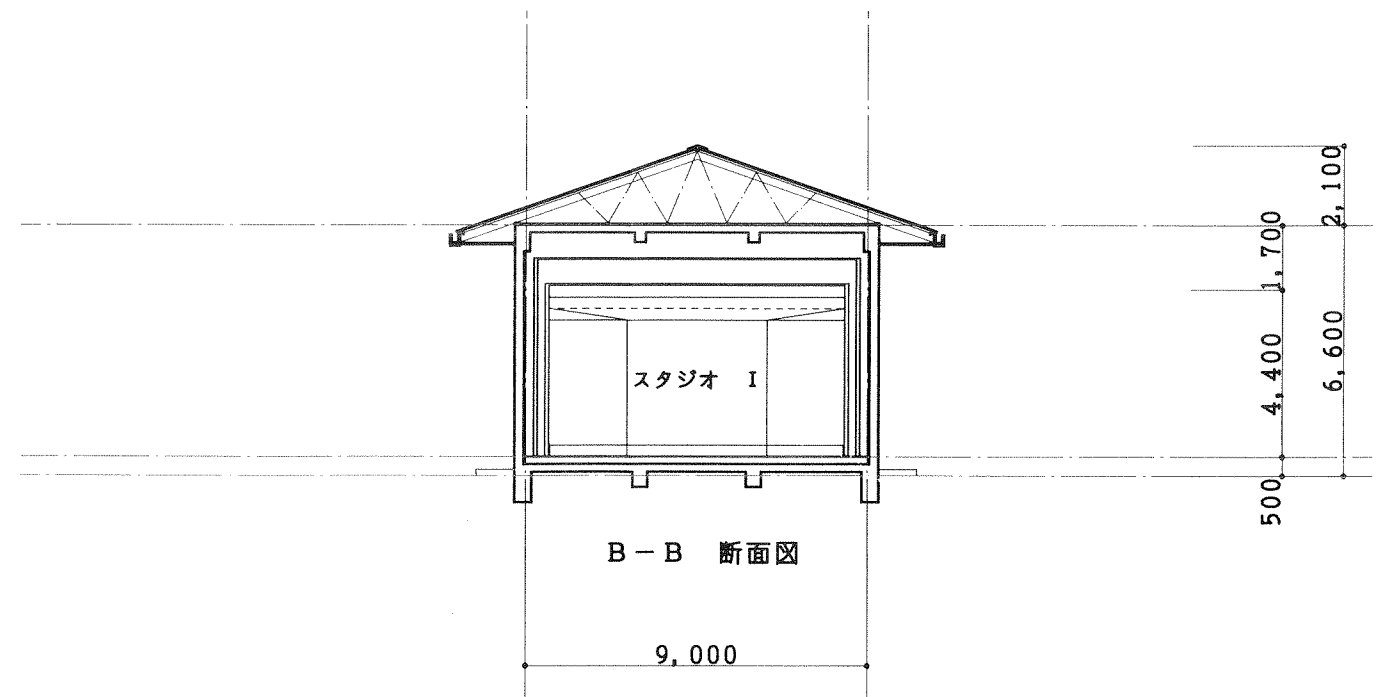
新スタジオ棟立面図 (2)・断面図 S=1/200
